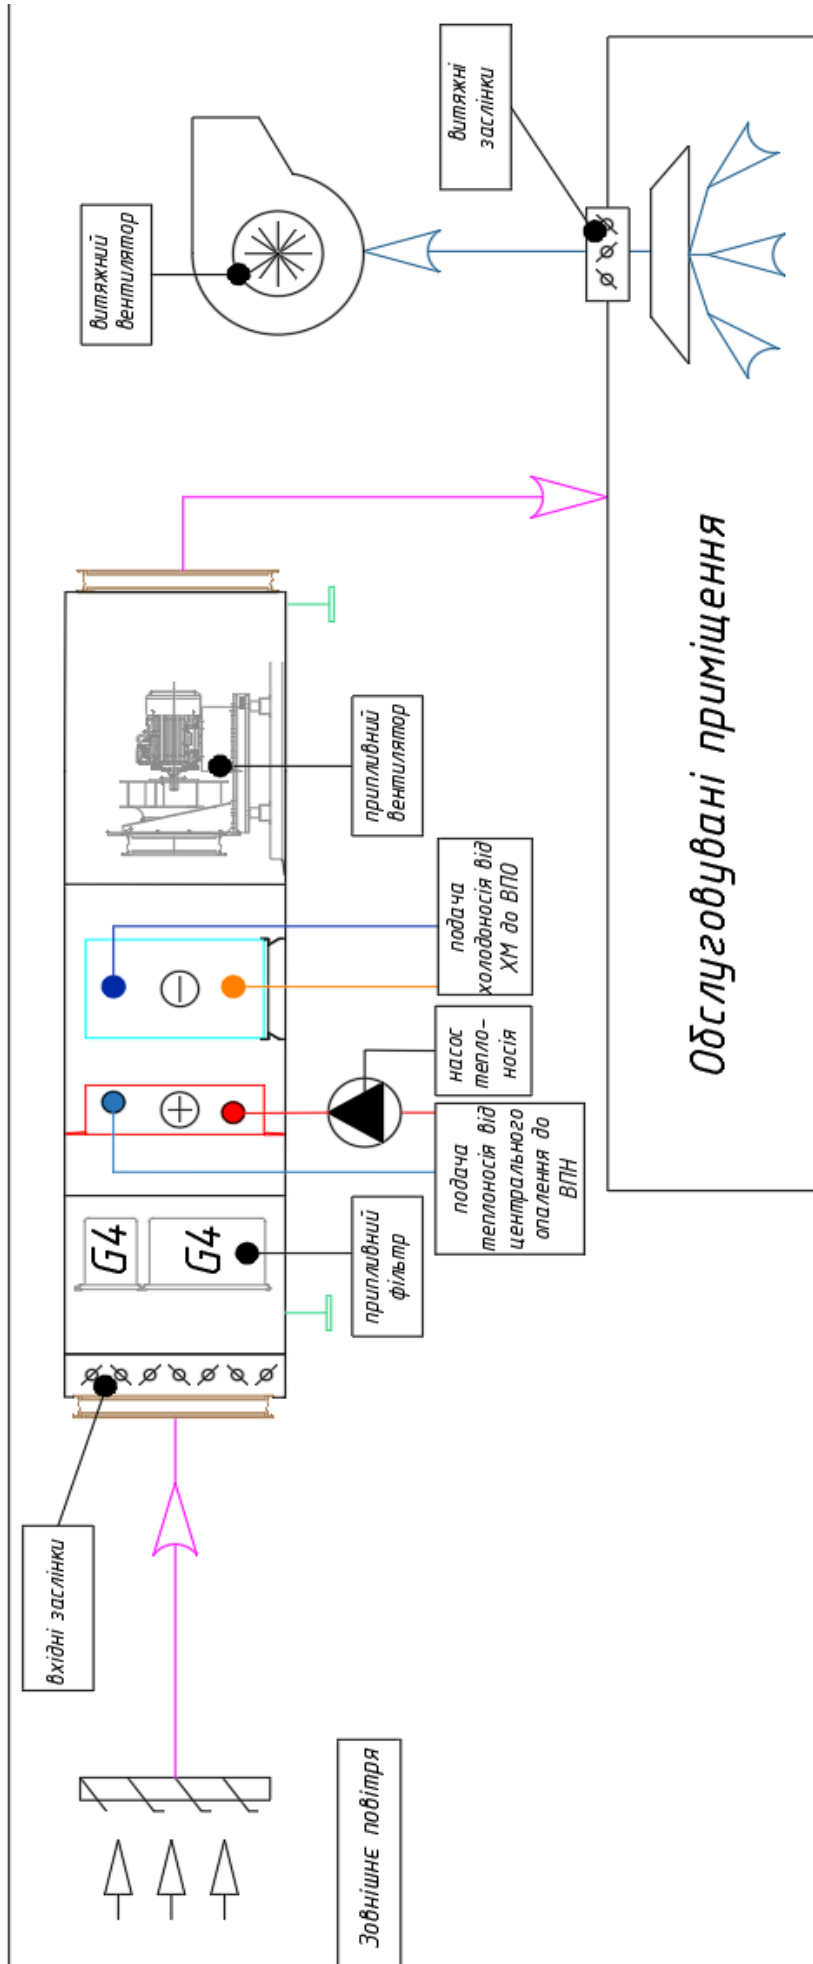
Принципова схема припливної установки, з місцевою витяжною
